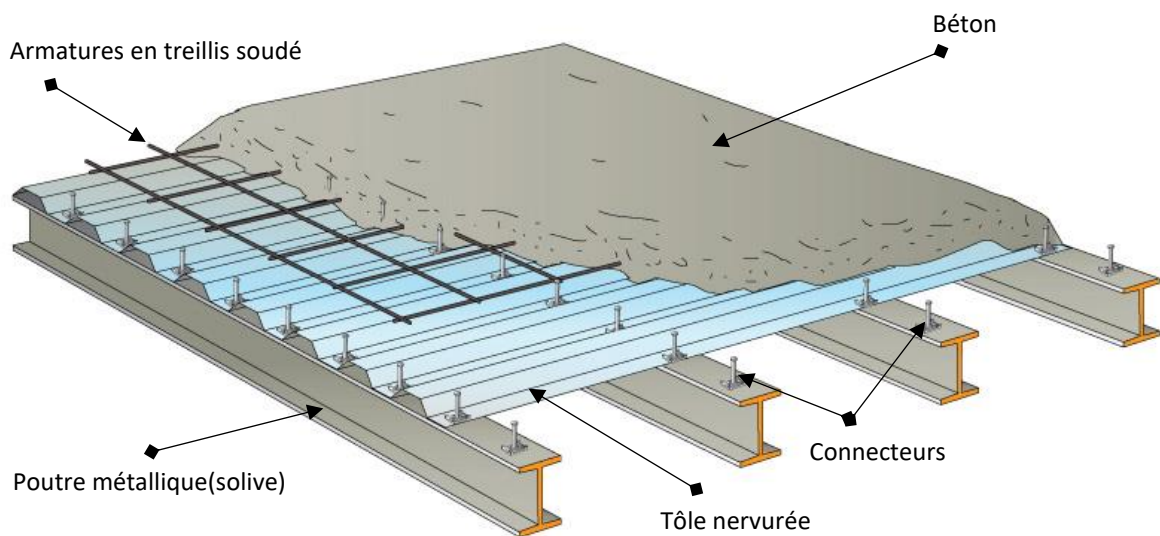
Éléments constitutifs d'un plancher collaborant
